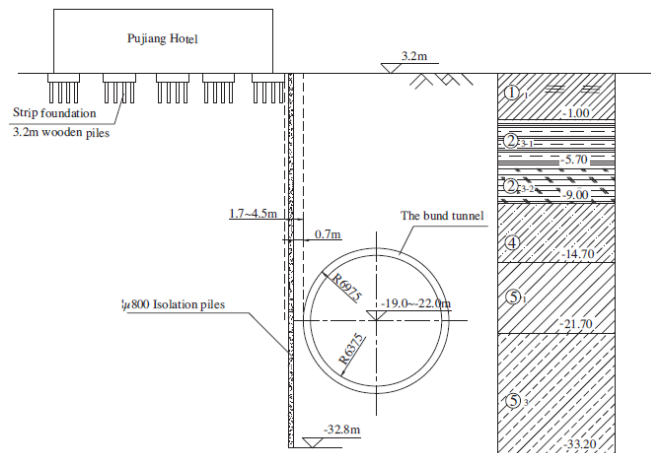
Schéma de la coupe transversale du tunnel au niveau du Pujiang Hotel (Bai, Y et al., 2014)
